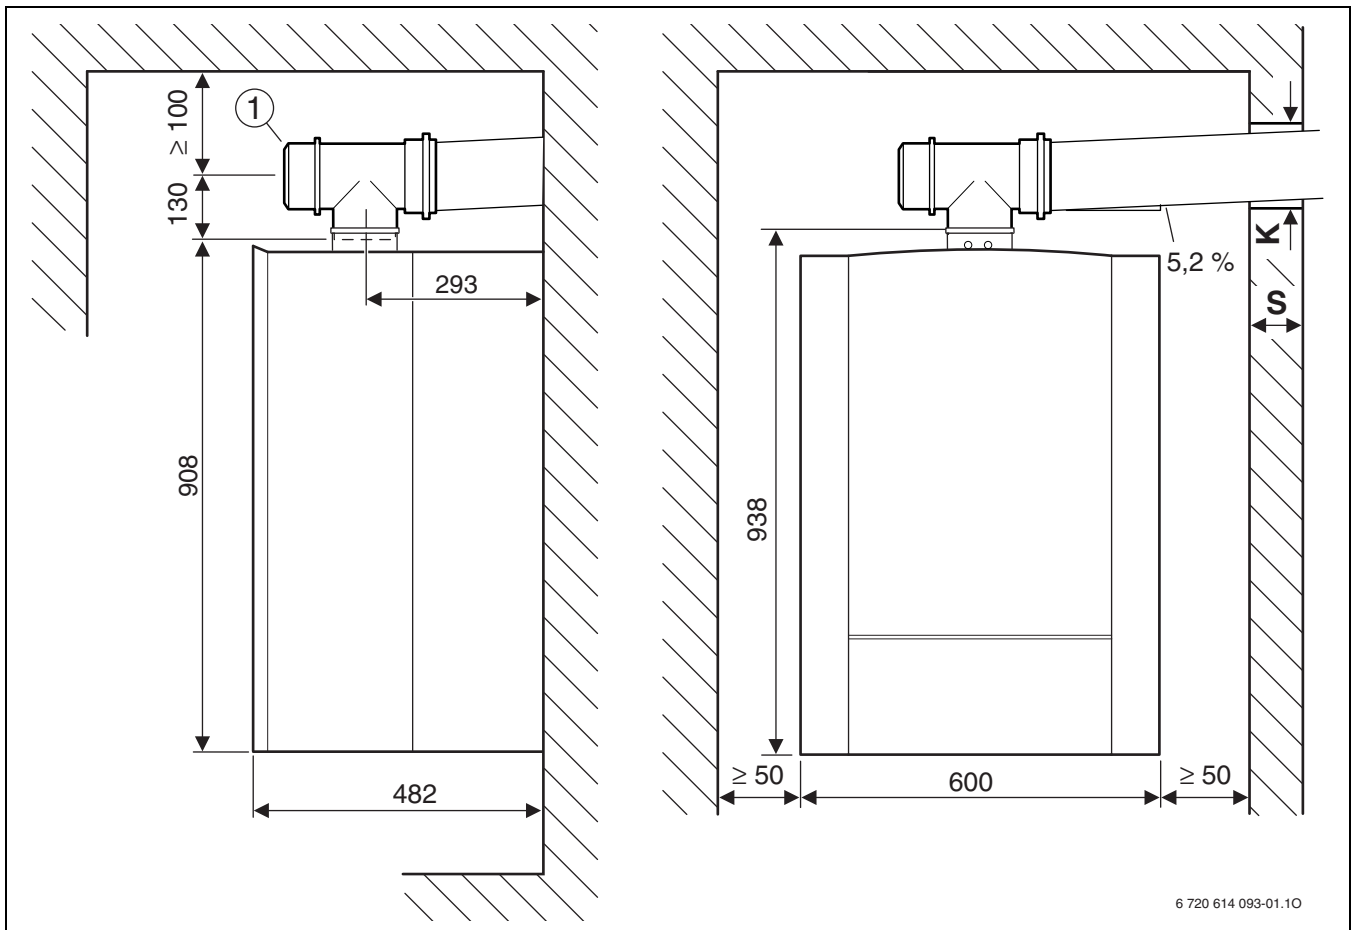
Abgasführung Ø 80/125 mm oder Ø 80 mm
